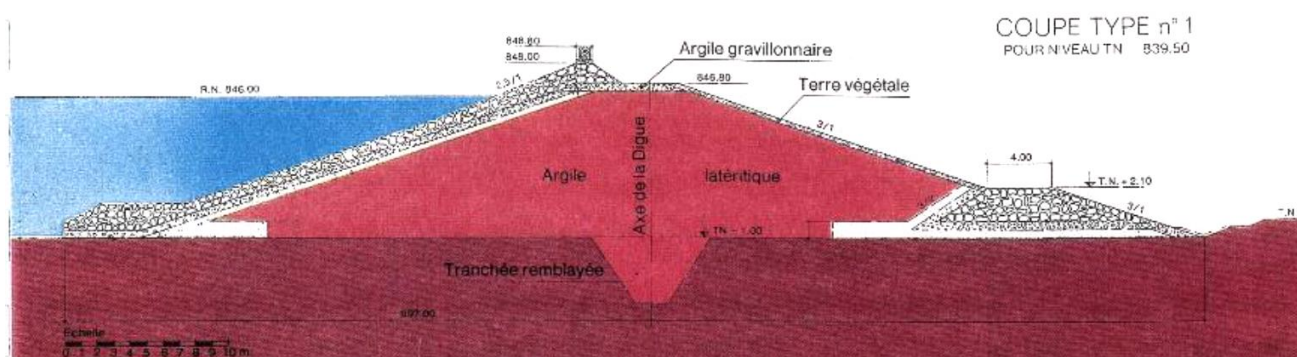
Coupe type des digues en remblais du barrage principal – Mbakaou
